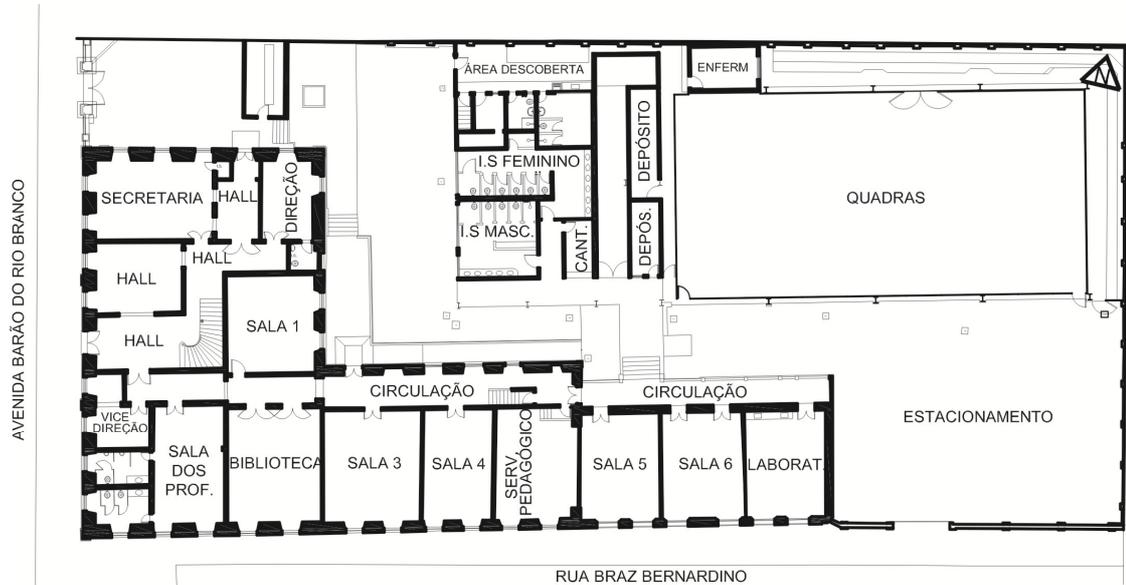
Implantação e identificação do Palacete Santa Mafalda
